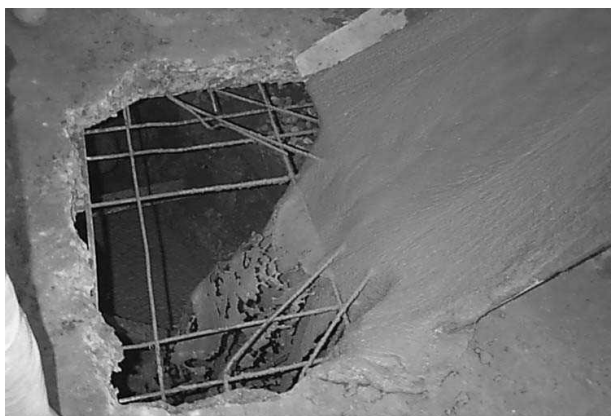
Lançamento da argamassa fluida para preenchimento de vazio ocorrido abaixo da laje.
